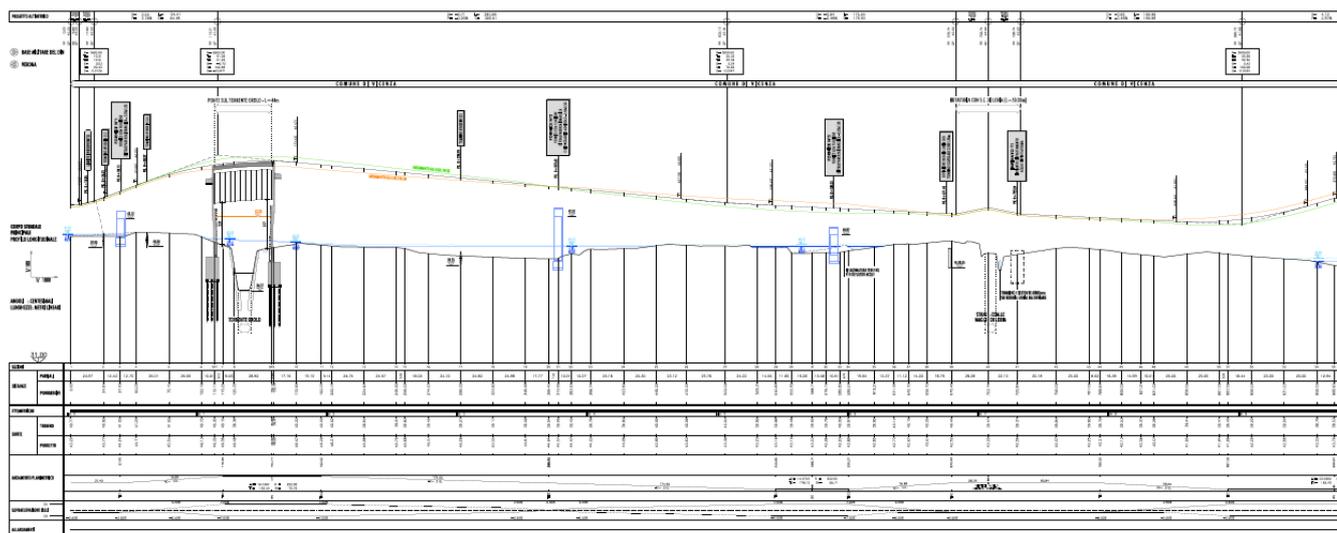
Profilo longitudinale di progetto – 1^ parte
